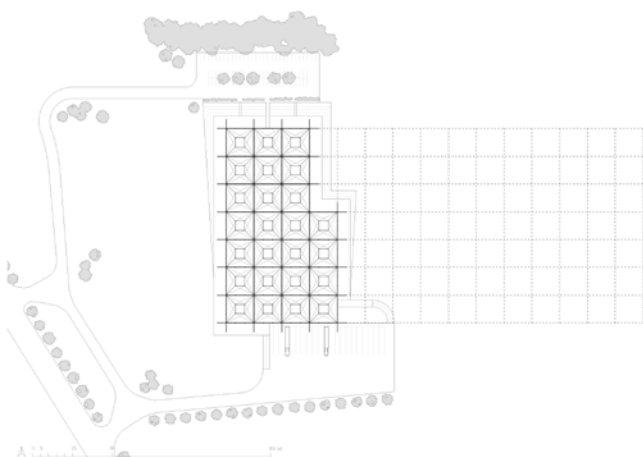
Planta de la cubierta de la fábrica Fleetguard.
